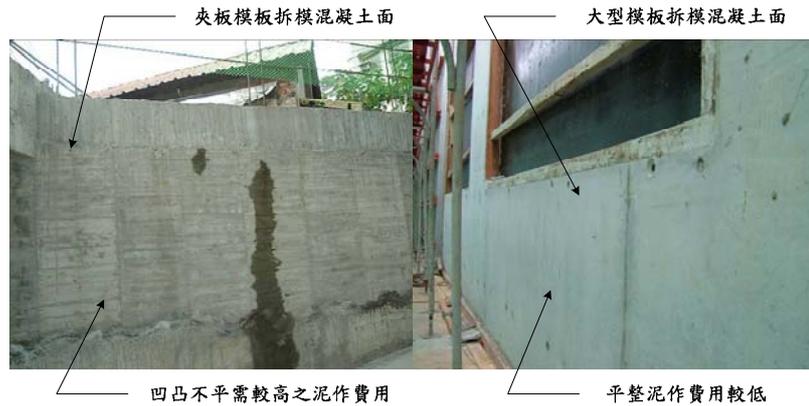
夾板模板與大型模板在拆除模板後，混凝土面示意
